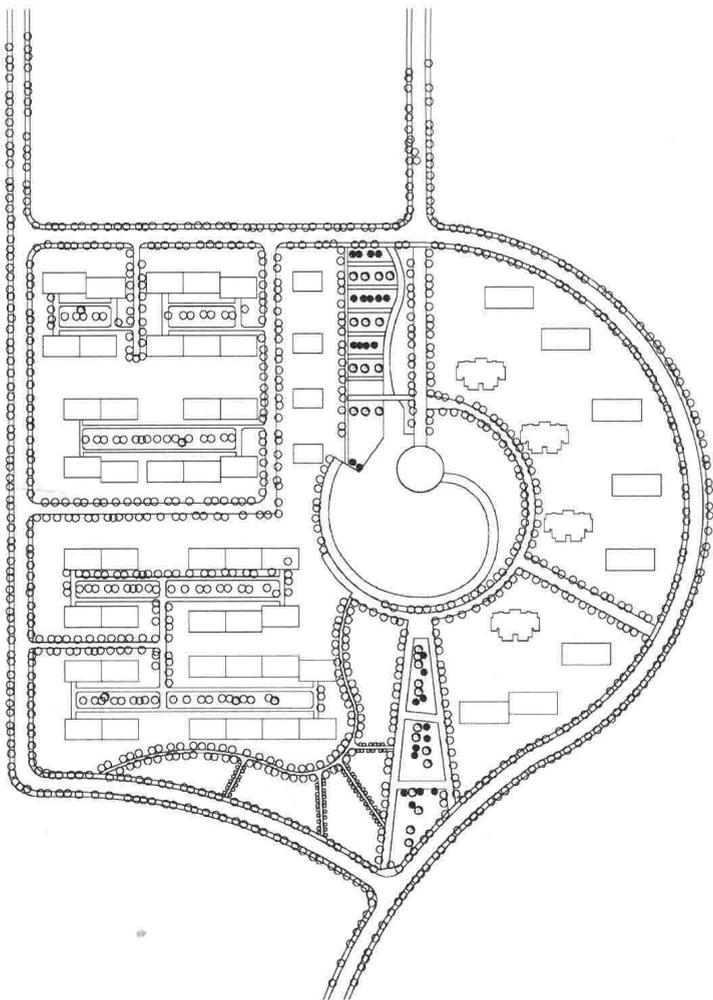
用 AutoCAD 绘制的居住区规划平面图
